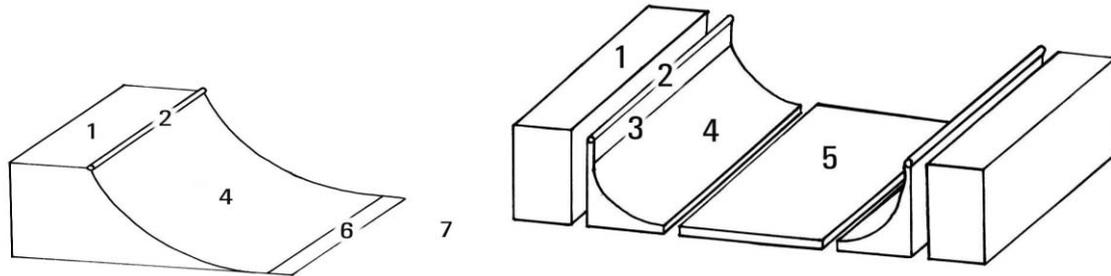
Konstruktionsdetails am Beispiel einer Coping Ramp (links) und einer Halfpipe (rechts)
